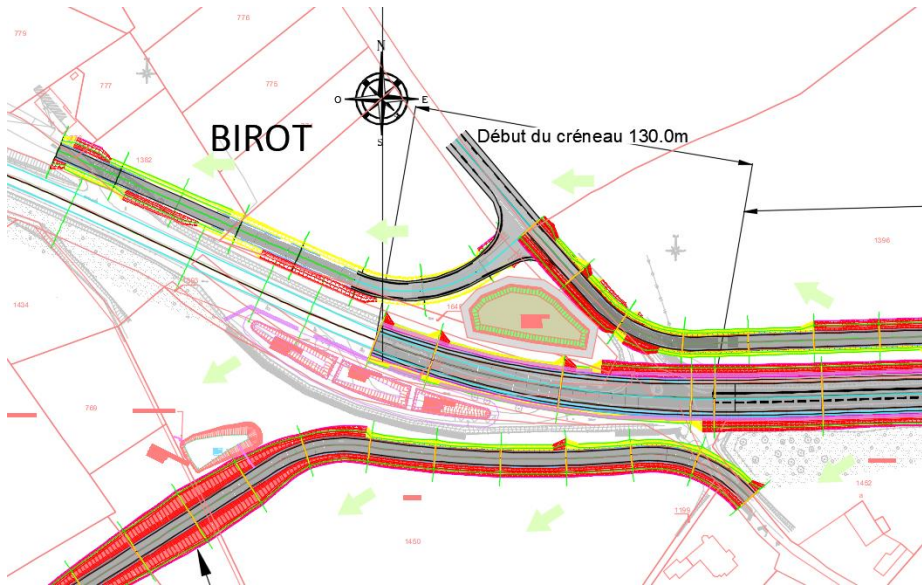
plan de détail de la sortie du giratoire des Fontenelles à 2 voies
